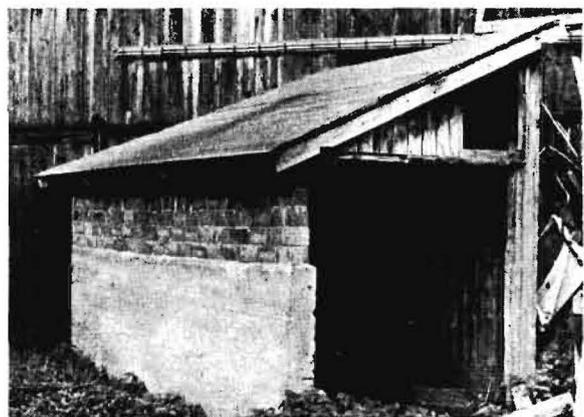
Einfacher Schalldämpfer bestehend aus einer Schalldämmwand aus Beton und Mauerwerk, einer Holzwand und einem Holzdach für einen schnelllaufenden Axiallüfter
